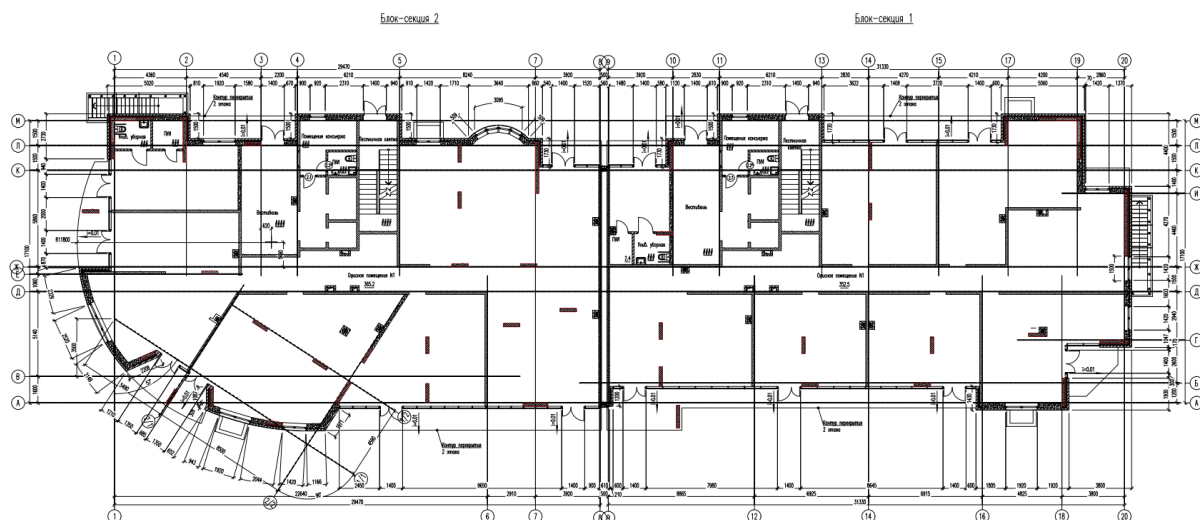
Схема 1-го этажа, Литер 5а, 5б
